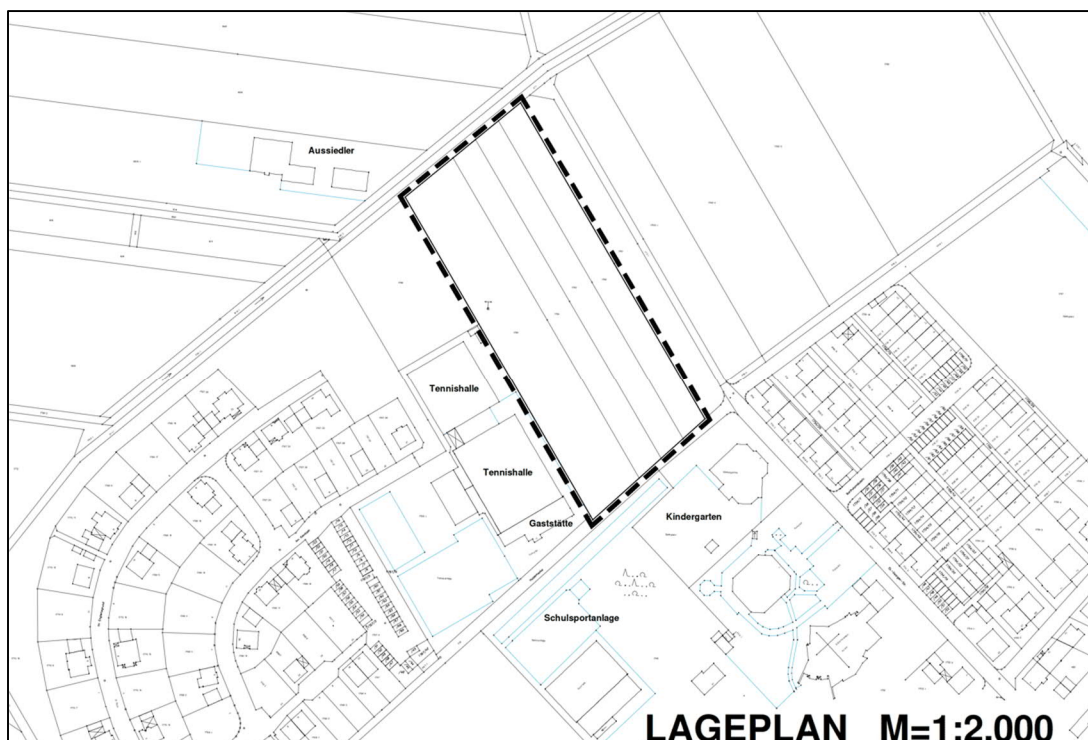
Lageplan mit Abgrenzung Plangebiet /2.1.1/
